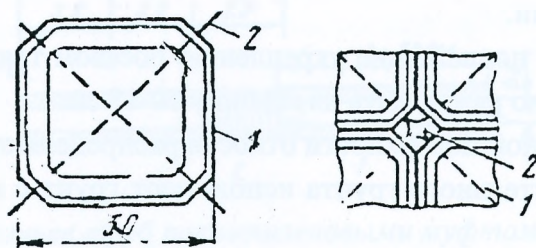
Бетонные плиты для укрепления временно подтапливаемых откосов земляного полотна: а – общий вид плиты; в – деталь сопряжения плит в углах; 1 – бетонная плита; 2 – выступающий конец арматуры.
